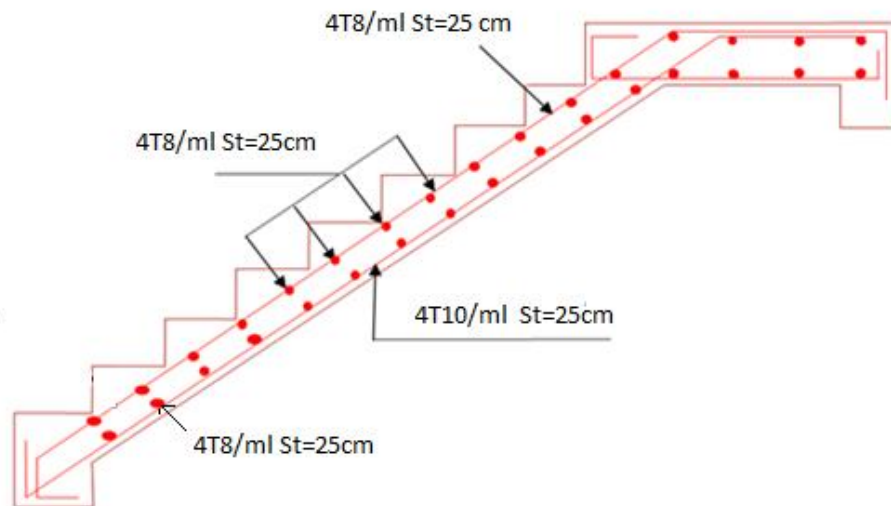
Ferrailage des volées(I),(III) d'escalier type 1
